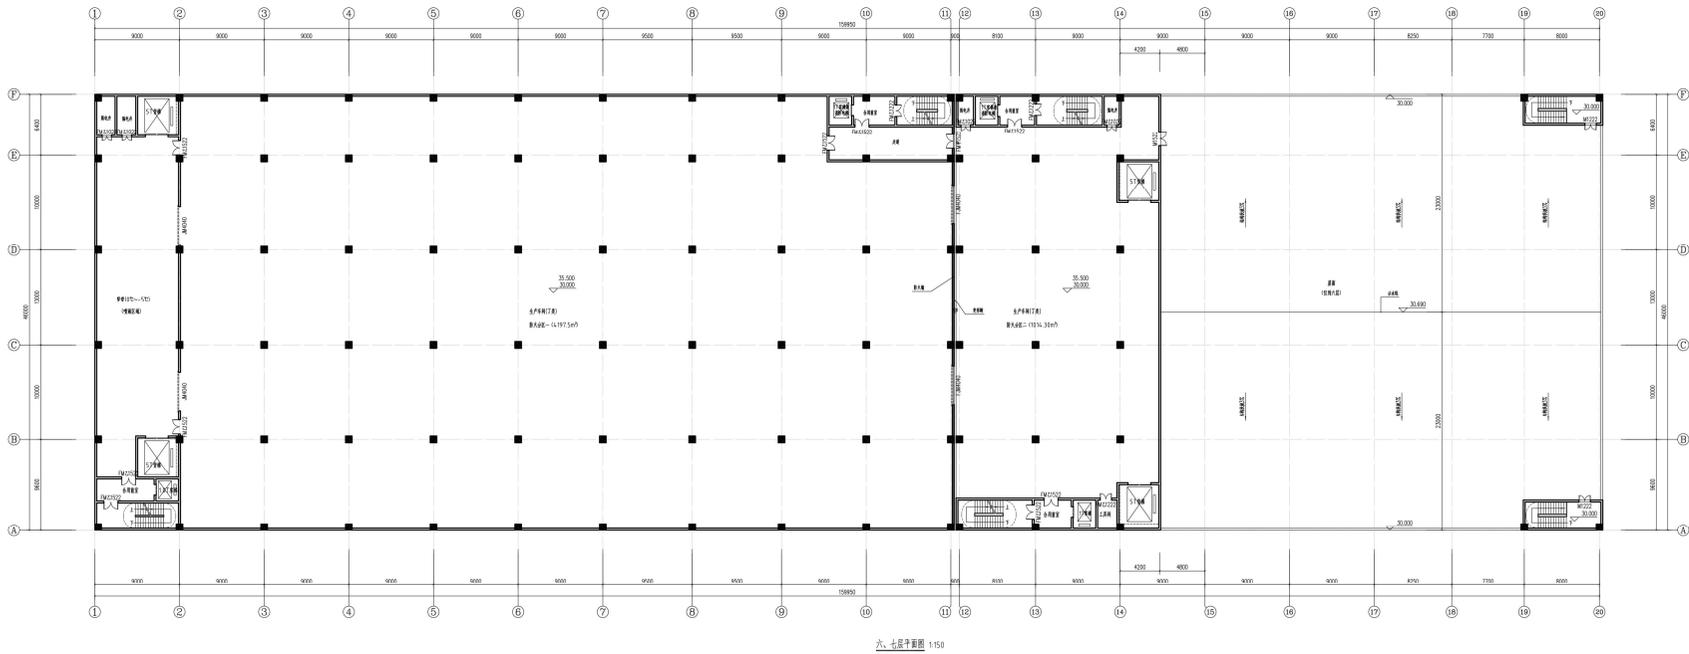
1#厂房天面层及2#厂房六、七层平面布置图
